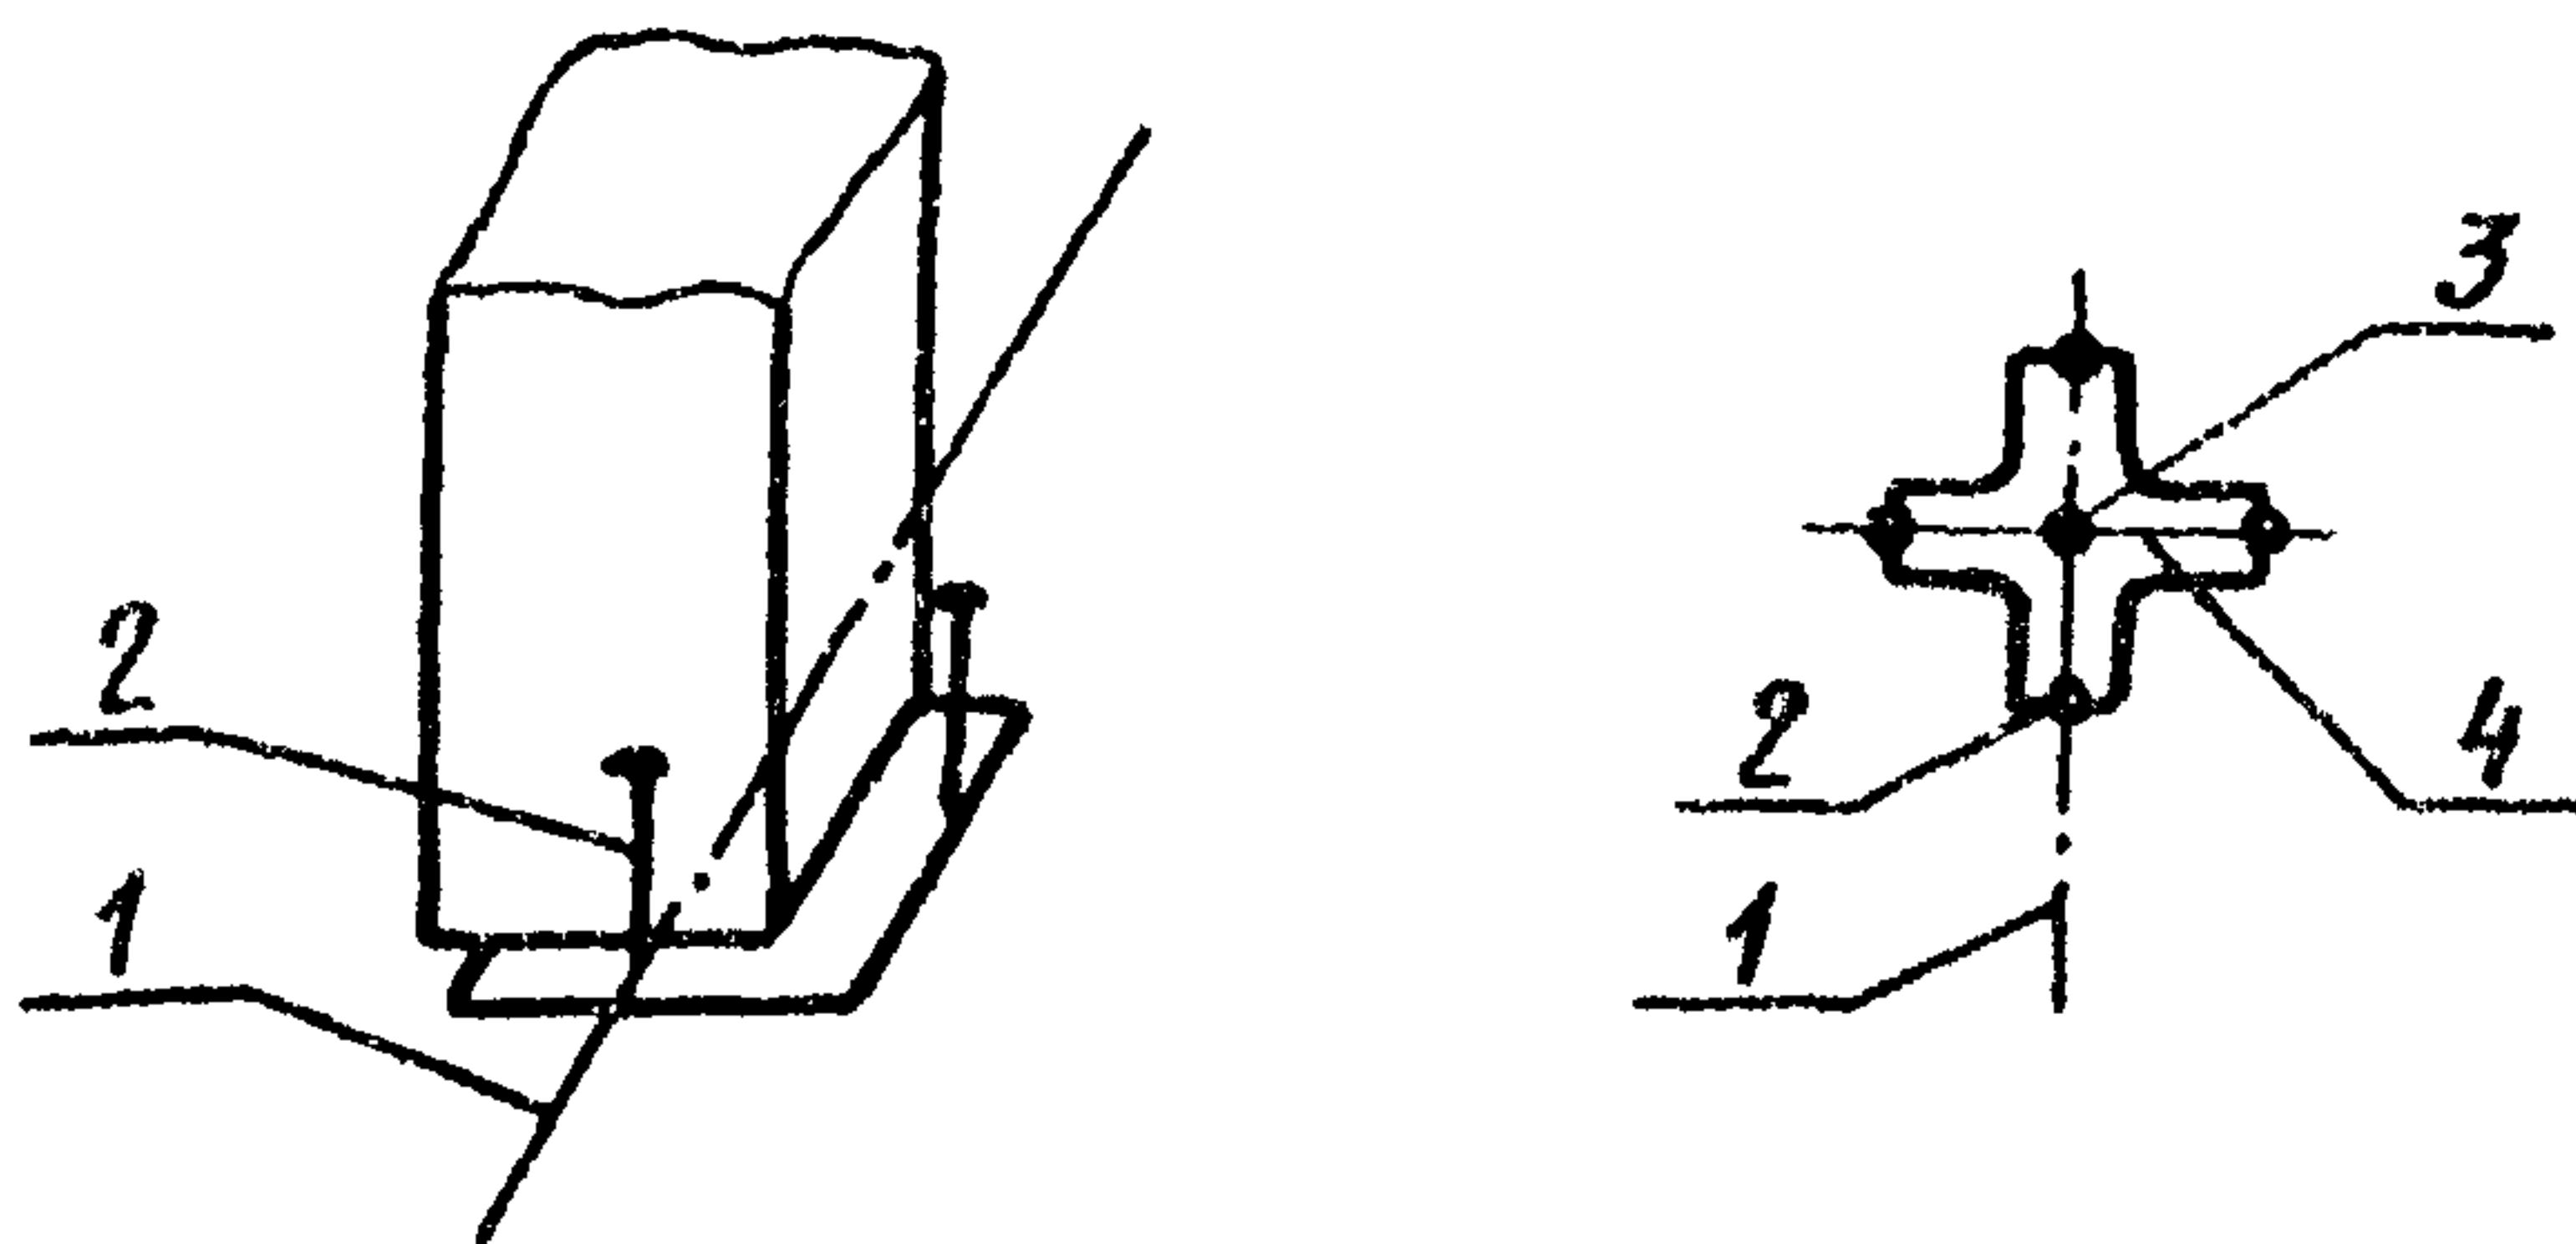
Схема установки свай на точку: 1-ось свайного ряда; 2-разметочный штырь; 3-установочный штырь, 4-шаблон
